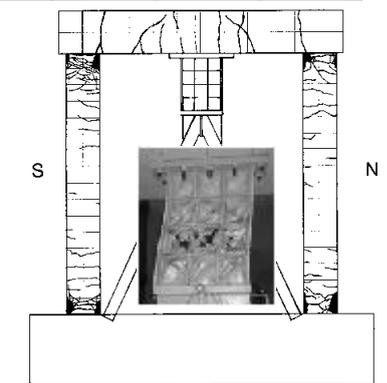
実験終了時のひび割れ状況 (SD 試験体)
